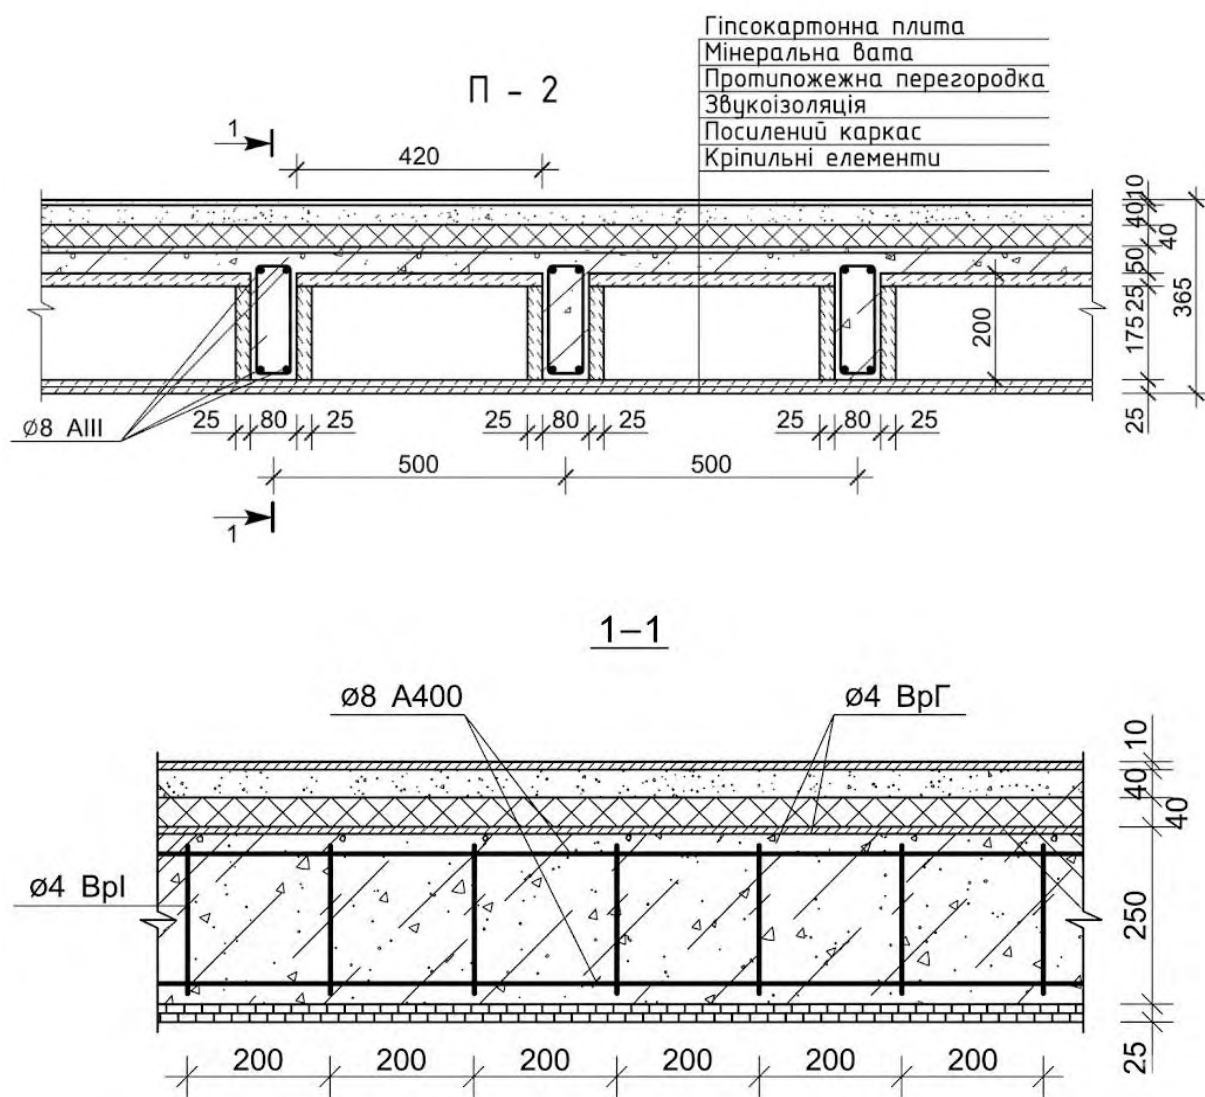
Схема влаштування перекрыття в системі з незнімною опалубкою з ЦСП.
